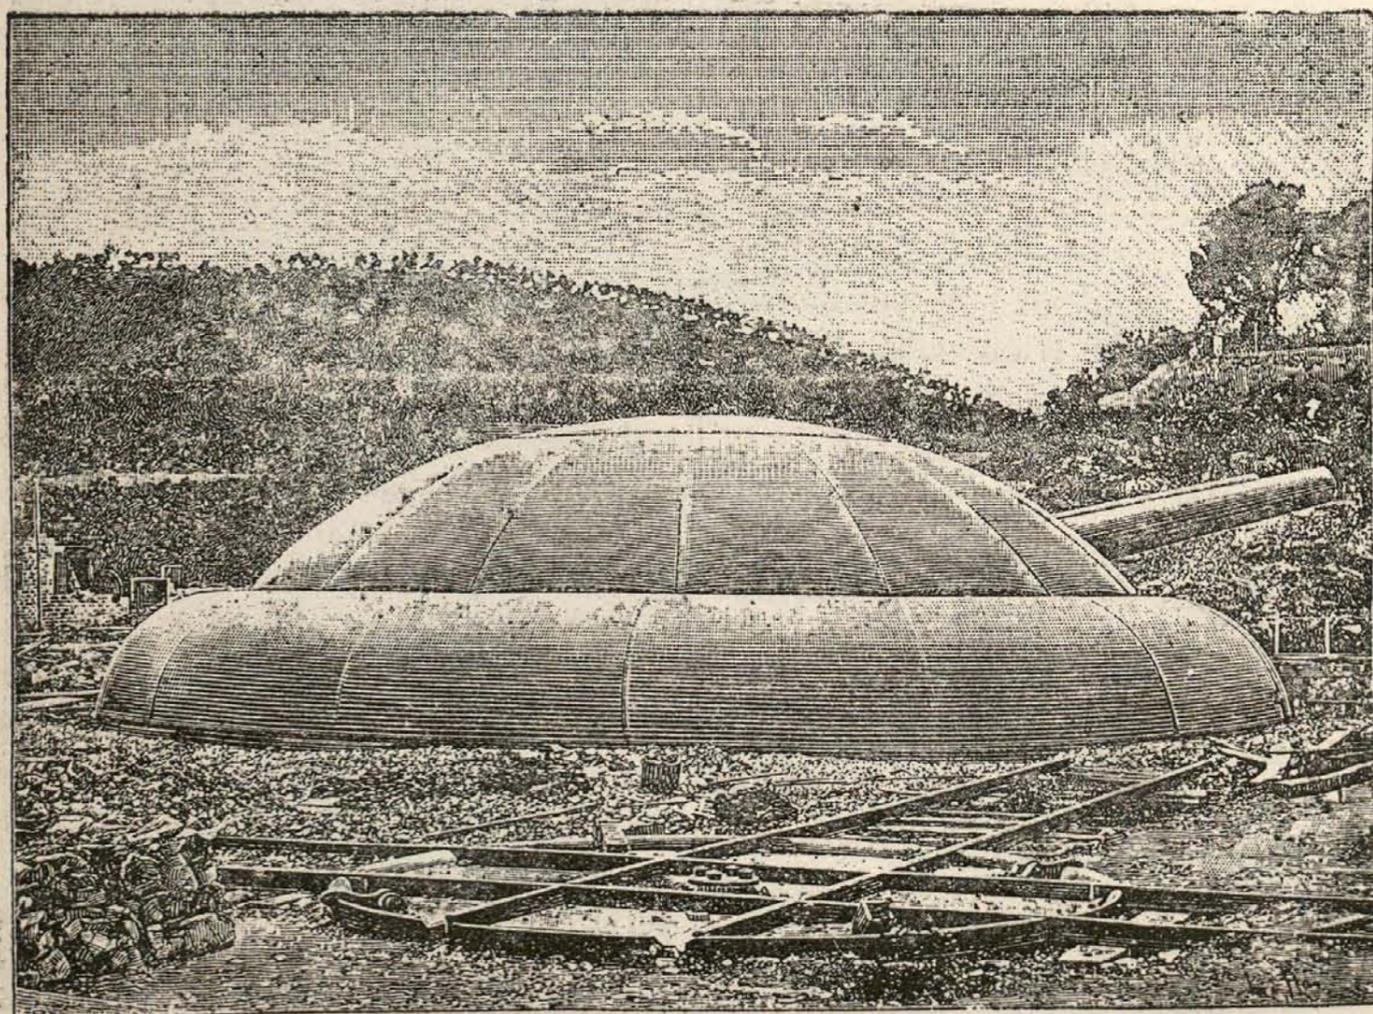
Cúpula en construcción para dos cañones de á 40 cm. sin el cerco de hormigón.
